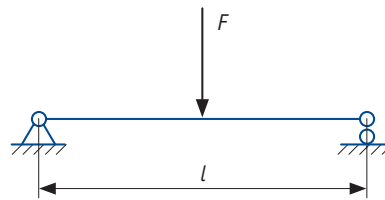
Схема поперечного нагружения трубобетонной балки сосредоточенной нагрузкой
